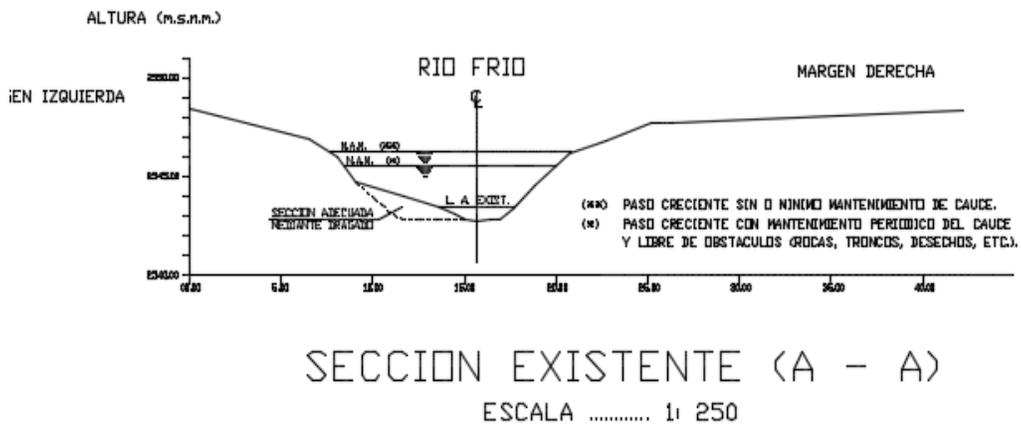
Sección vertical, estudio 1. Sector puente variante Chía-Cota. Fuente: elaboración propia.
